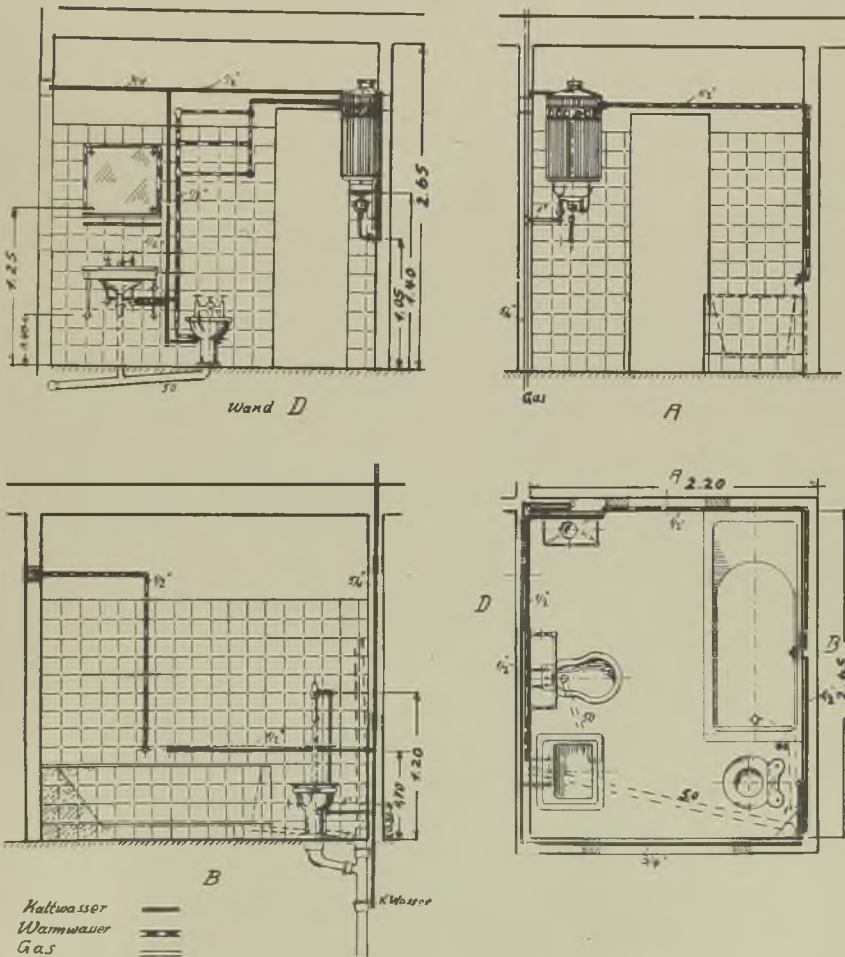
Grundriß und schematische Installationsflizzen zu einem Badezimmer (vgl. Kostenberechnung dazu).
